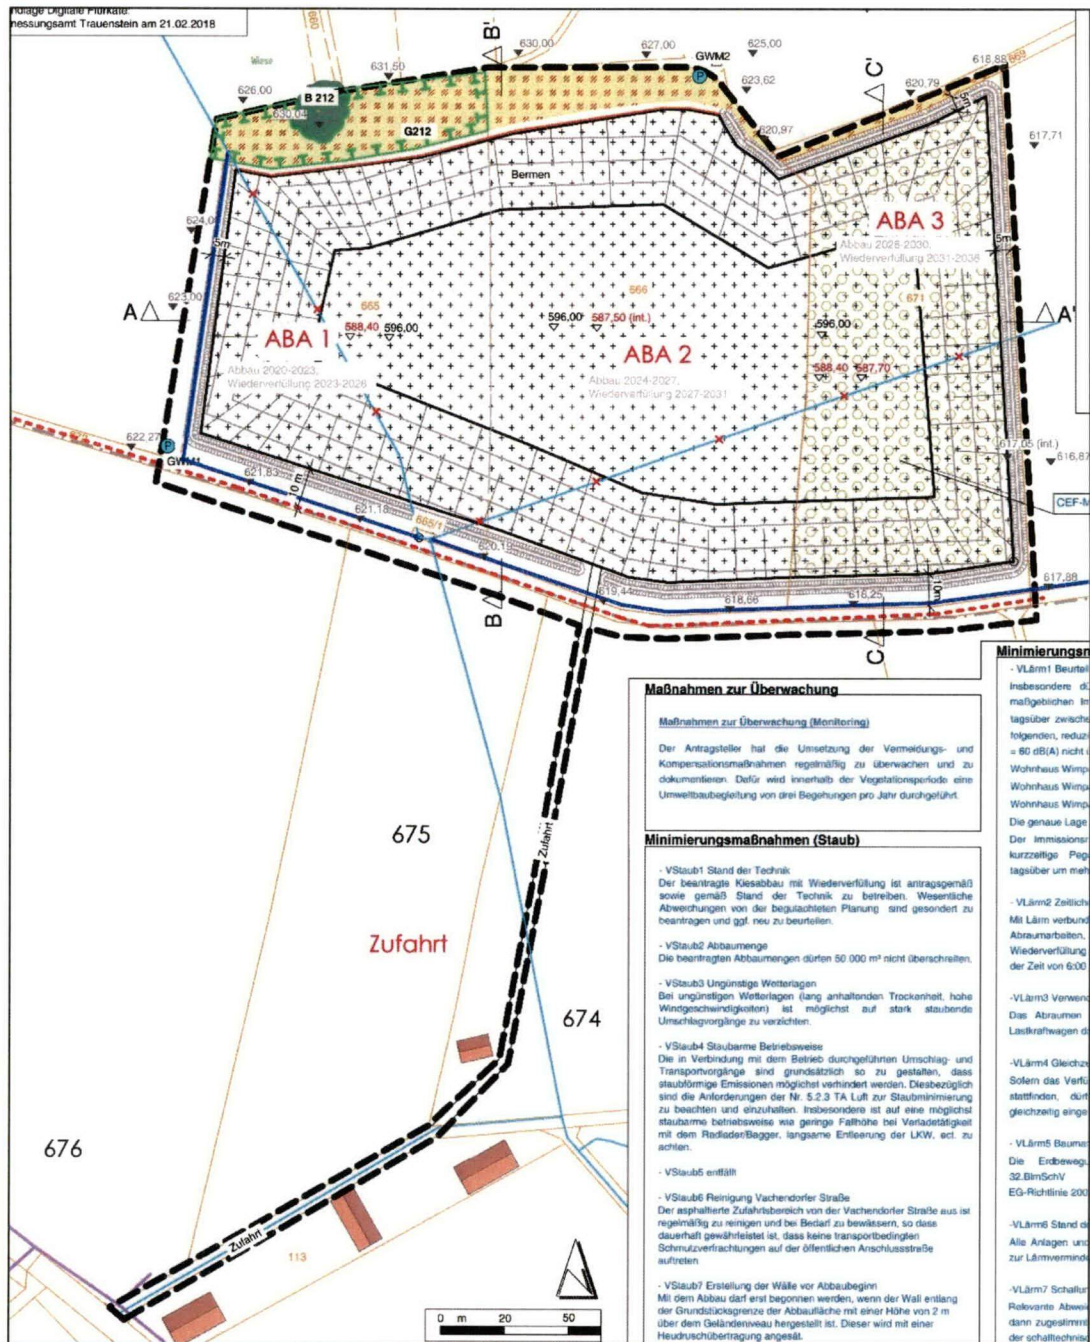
Abbauplan mit Darstellung der geplanten Zufahrt aus Süden /81/
